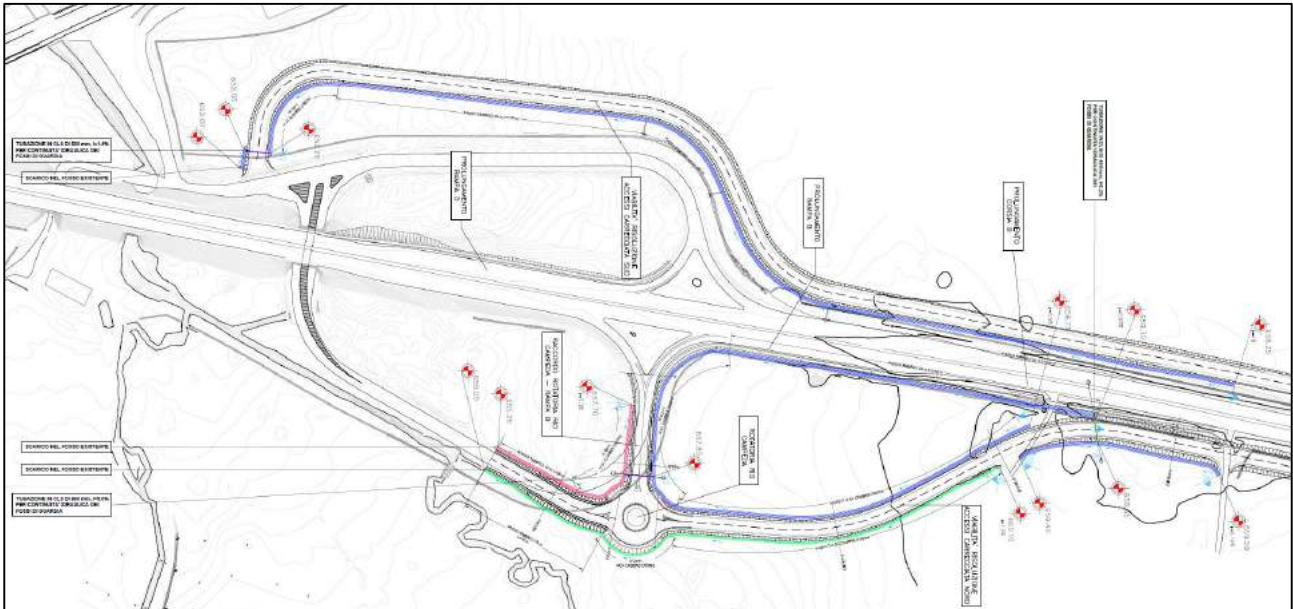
Stralcio planimetrico intervento V11-Svincolo Campeda al km 152
